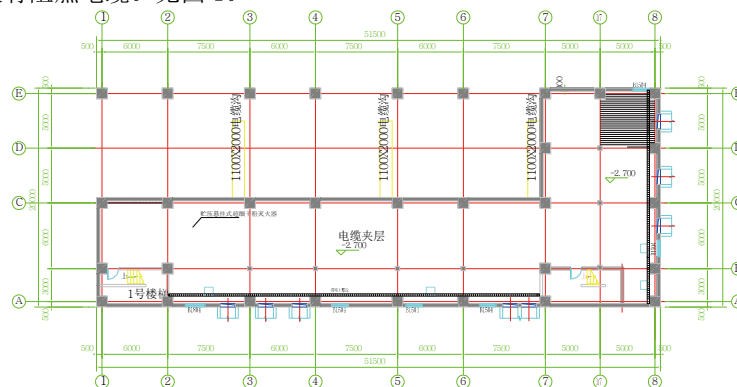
TJ-110-A2-3 方案电缆夹层平面布置图
